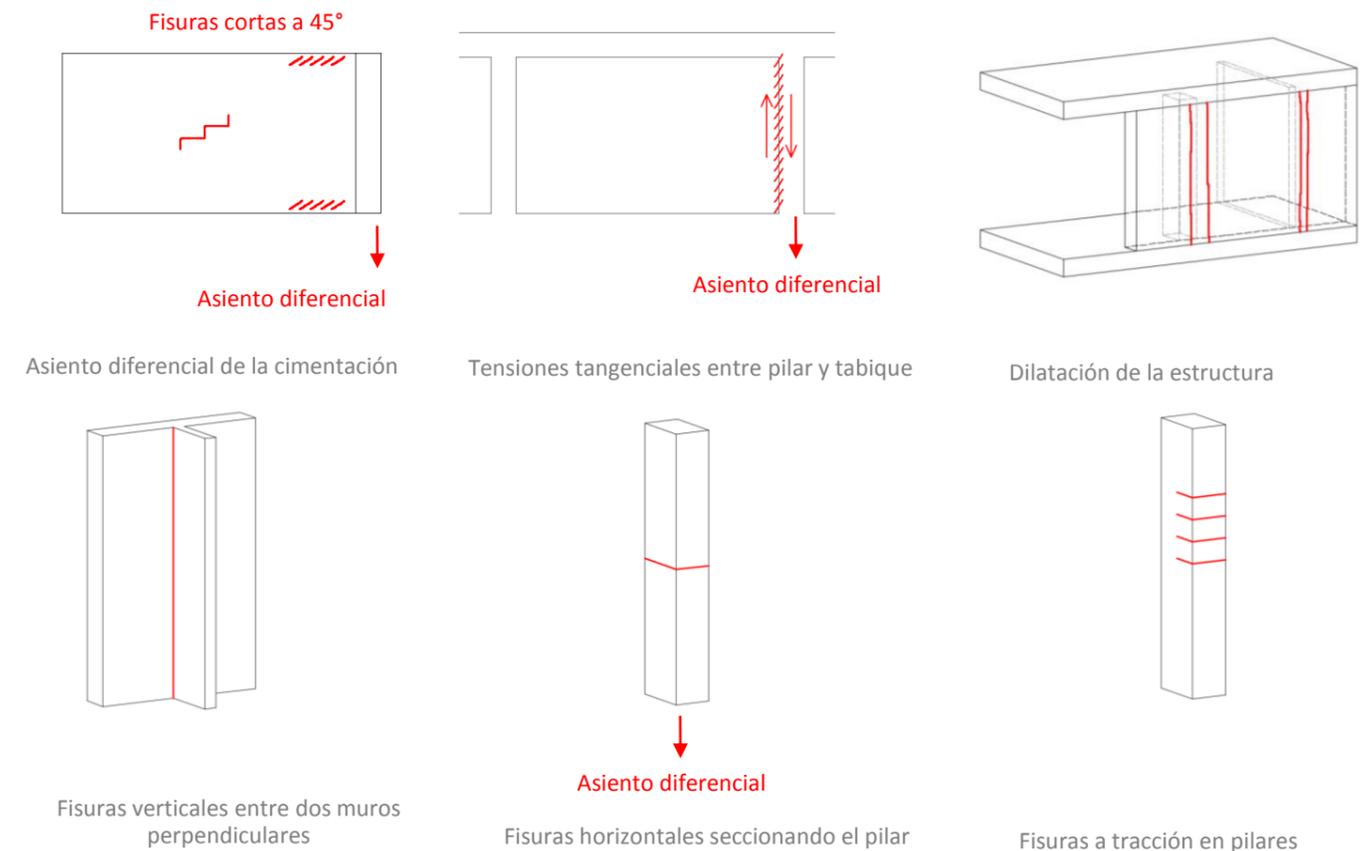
Tipos y causas de fisuras grandes/ grietas. 2018. Elaboración propia
